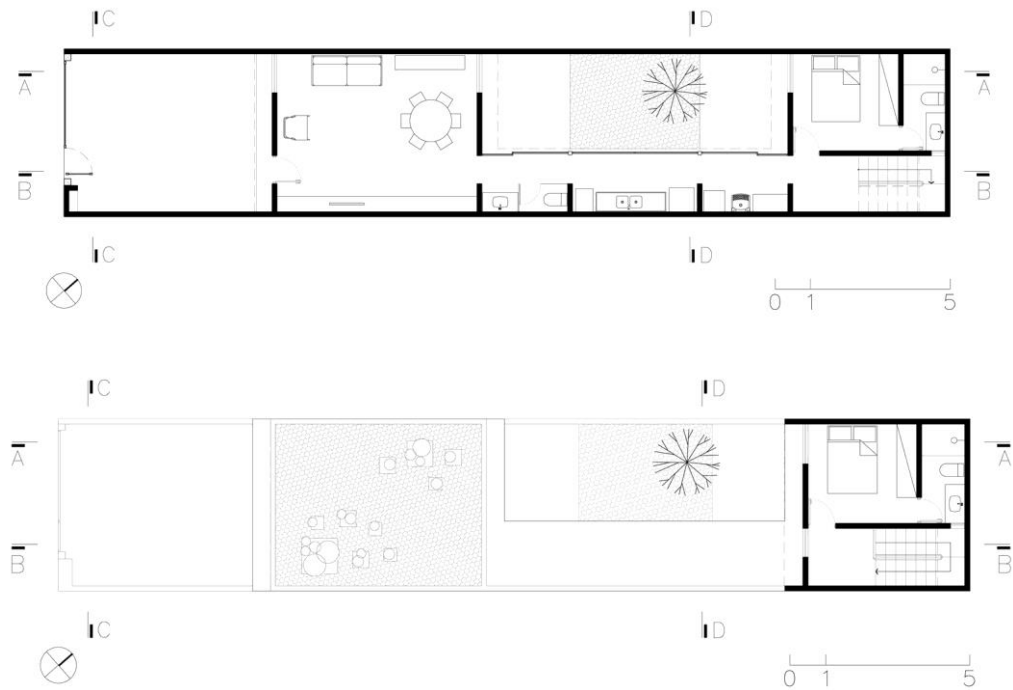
Plantas arquitectónicas Casa en Vila Matilda, Fuente:(Terra e Tuma,2011)
